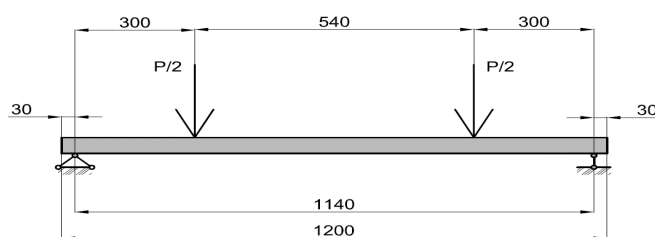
Схема випробування залізобетонних плит незнімної опалубки ПО–1,2,3.
